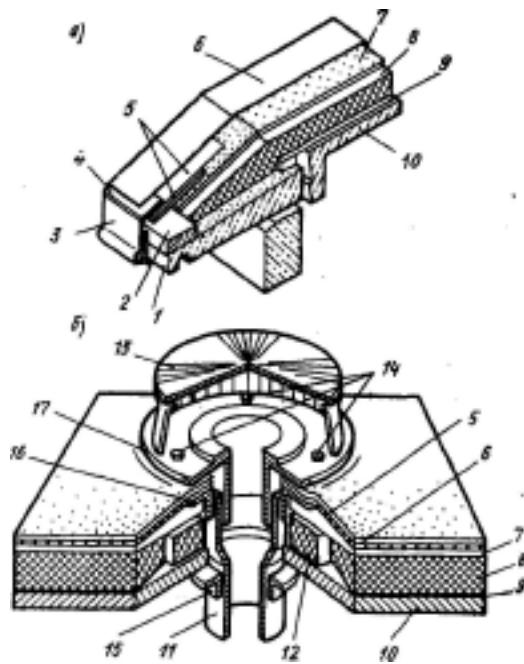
Конструкции отвода воды с покрытий промышленных зданий:
